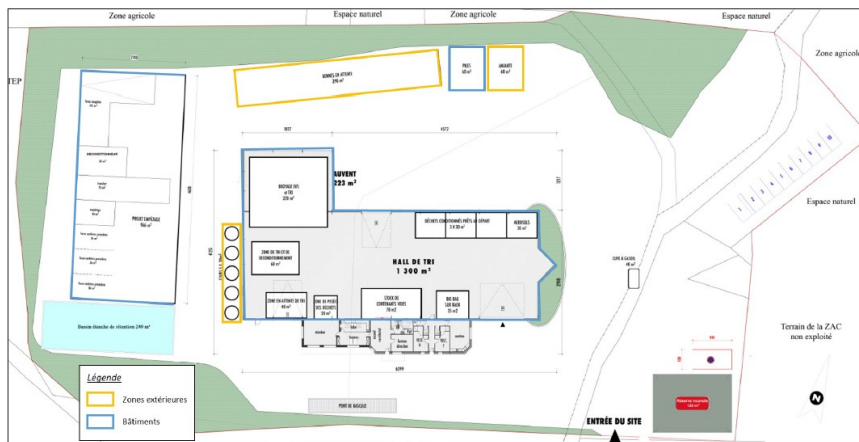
Plan d'agencement actuel du futur site (source étude d'impact)
